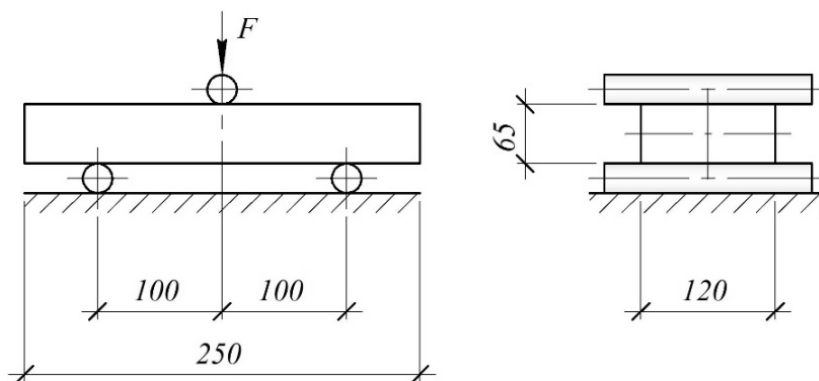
Схема испытания образца кирпича на изгиб
